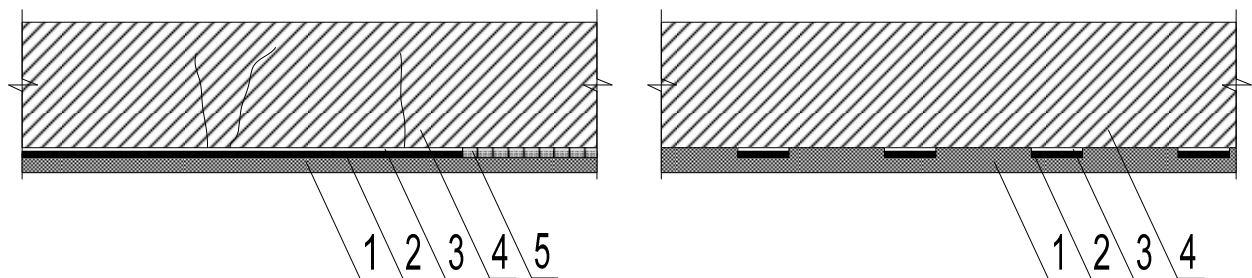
Схема аплікації композитних стрічок на залізобетонне перекриття:
